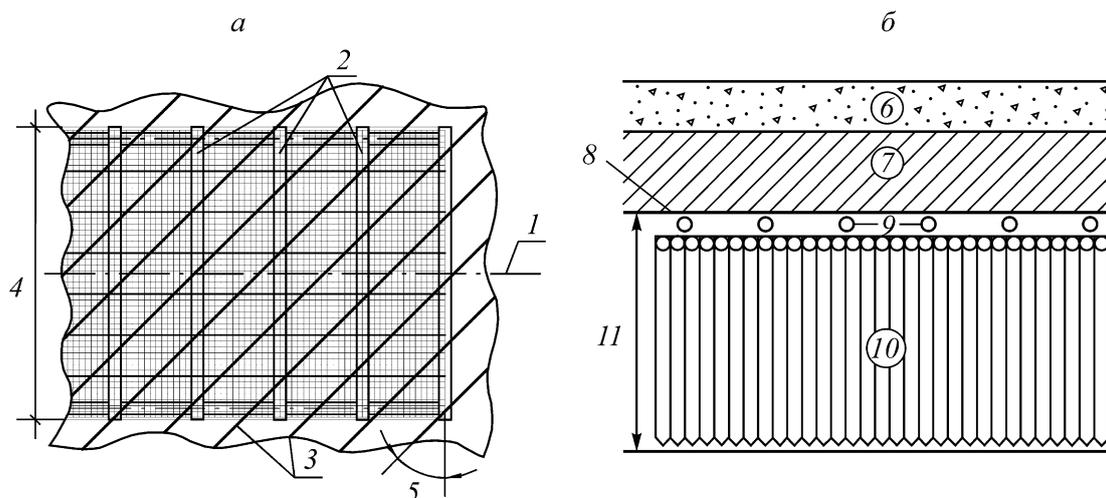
Система опережающей трубчатой крепи (а) и схематический вертикальный разрез системы трубчатой крепи (б): 1 — ось очистной ленты; 2 — затяжка сплошной деревянной крепью (неполный дверной оклад); 3 — опережающая крепь (металлическая труба); 4 — ширина очистной ленты; 5 — угол между осями скважин опережающего крепления и очистными лентами; 6 — обводненные донные отложения; 7 — предохранительный рудный целик; 8 — граница безопасной глубины разработки; 9 — опережающая крепь (металлическая труба); 10 — затяжка сплошной деревянной крепью (неполный дверной оклад); 11 — первый подкарьерный слой отработки
